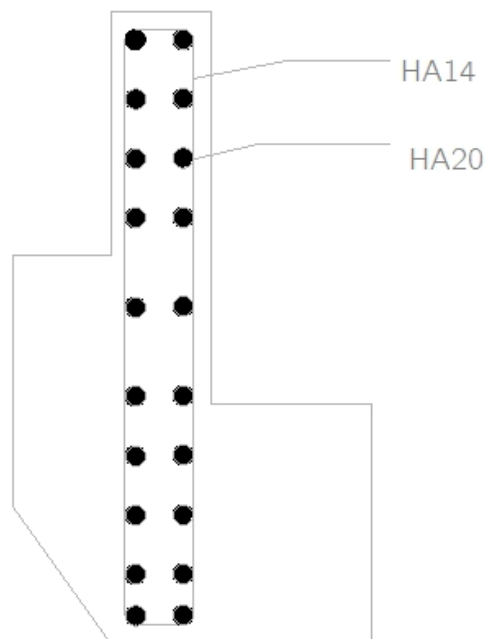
Schéma de ferrailage du mur garde-grève
